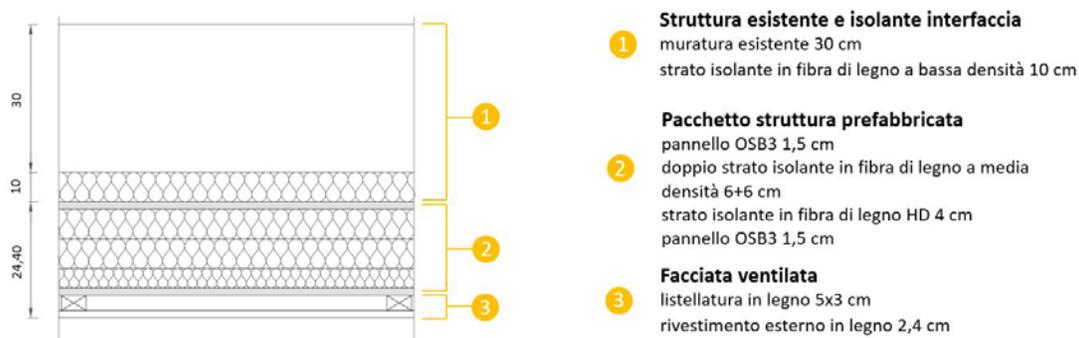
Pacchetto costruttivo con pannelli di isolante a diversa densità
